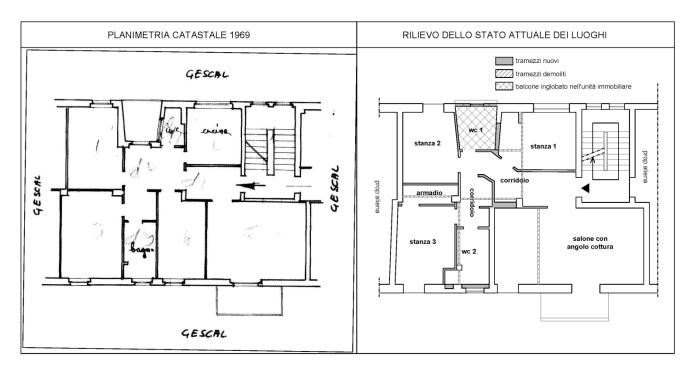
Confronto tra la planimetria catastale e il rilievo dello stato dei luoghi con individuazione delle difformità
